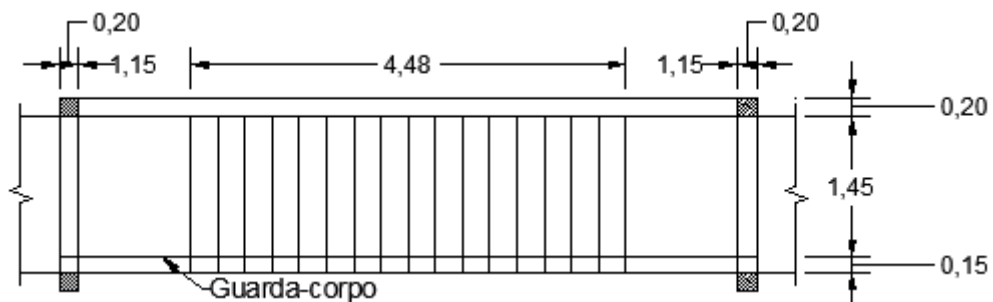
Vista superior da escada de um lance, armada longitudinalmente. As medidas estão apresentadas em metros (Fonte: autor).
